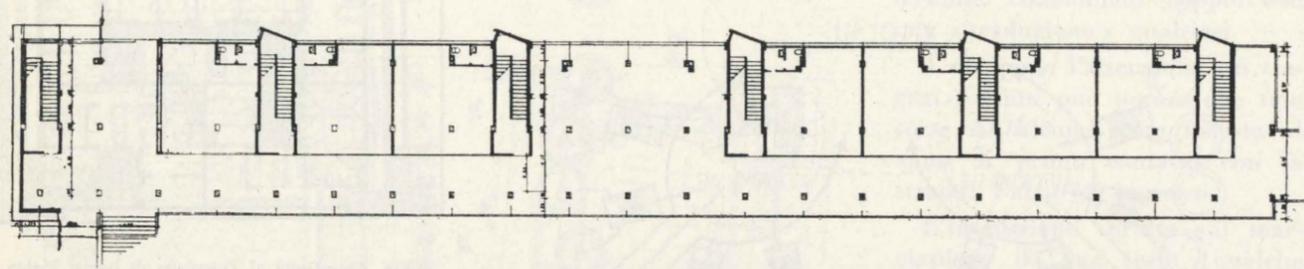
Pianta dell'edificio dell'illustrazione precedente.
